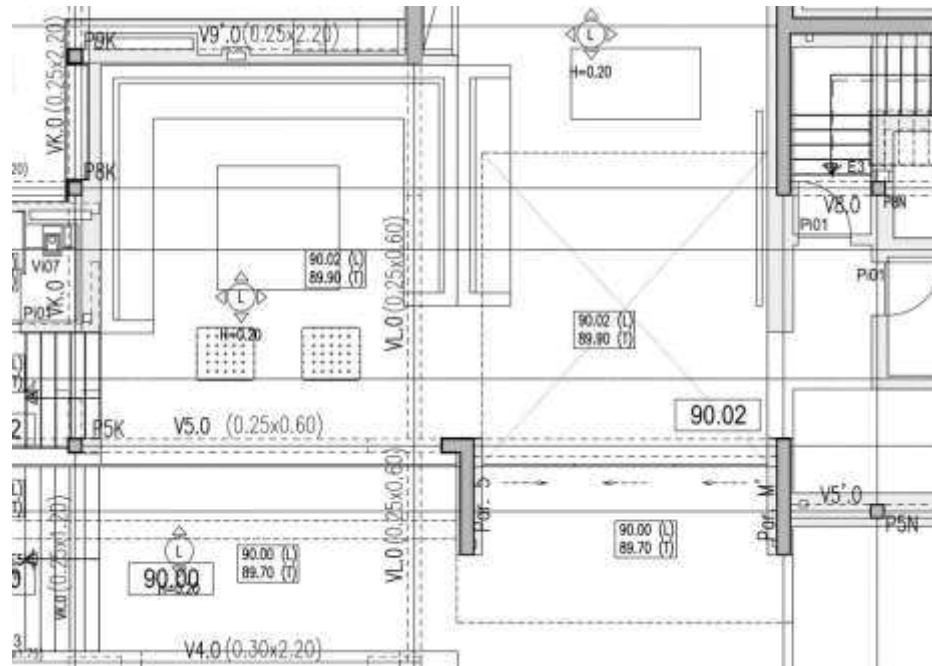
Compatibilização dos Pilares P5 e PM', anulação da Viga V8 e Pilar P8k
